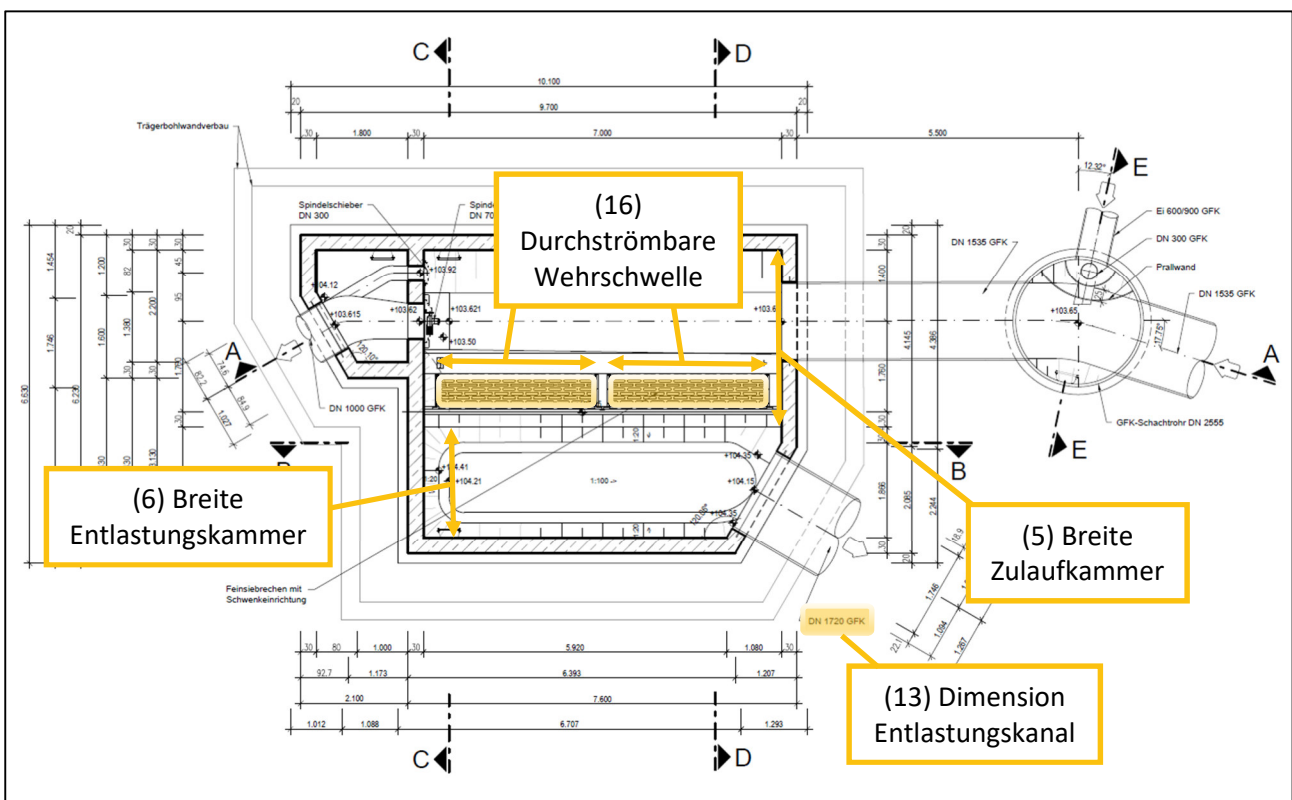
Beispiel Mischwasserentlastungsbauwerk Grundriss
